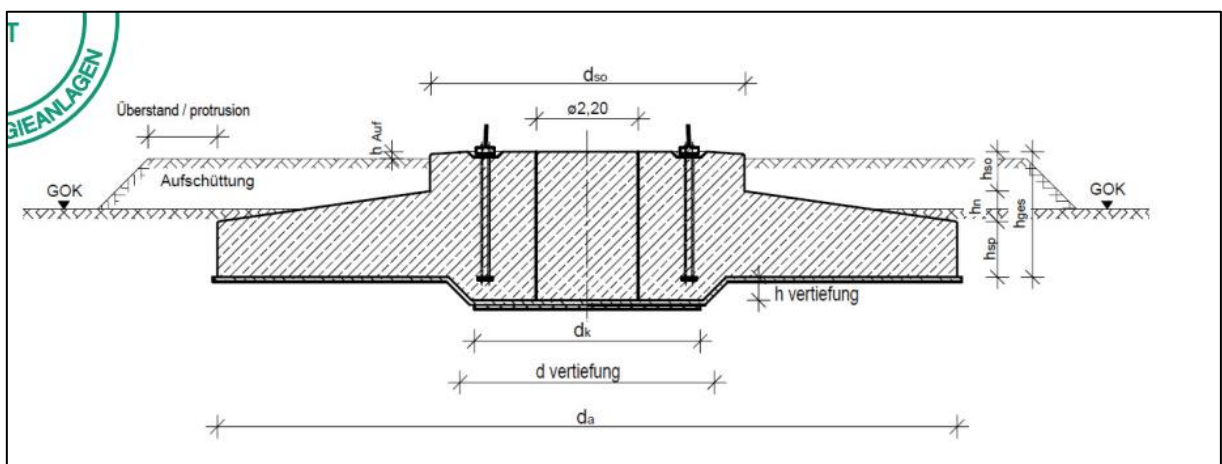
Schéma d'une fondation dite 'hors sol' (source : Enercon, 2020).
